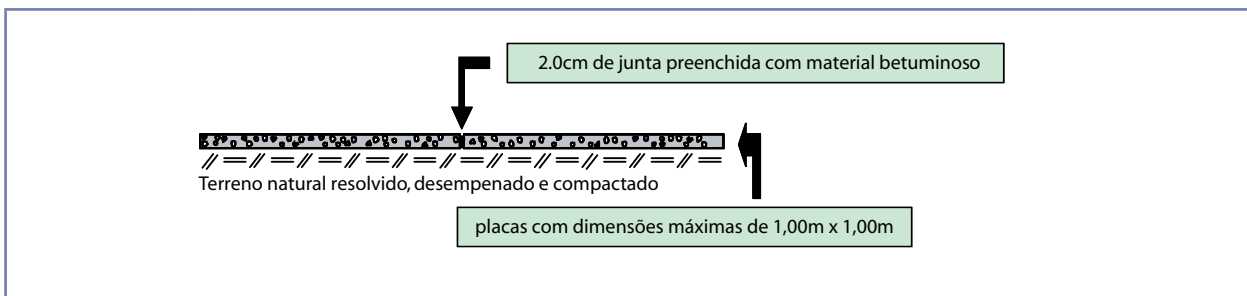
Pavimento de concreto em placas pré-moldadas.
